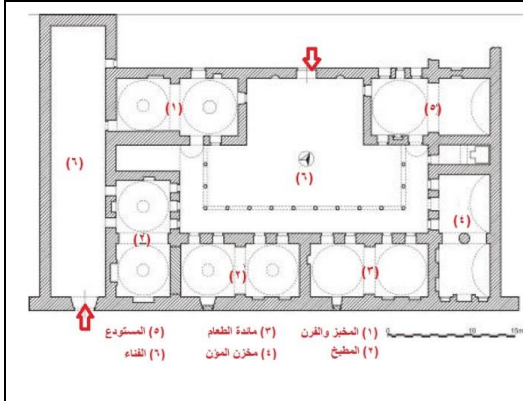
مسقط أفقى لعمارت خاصكى خرم بإستانبول
